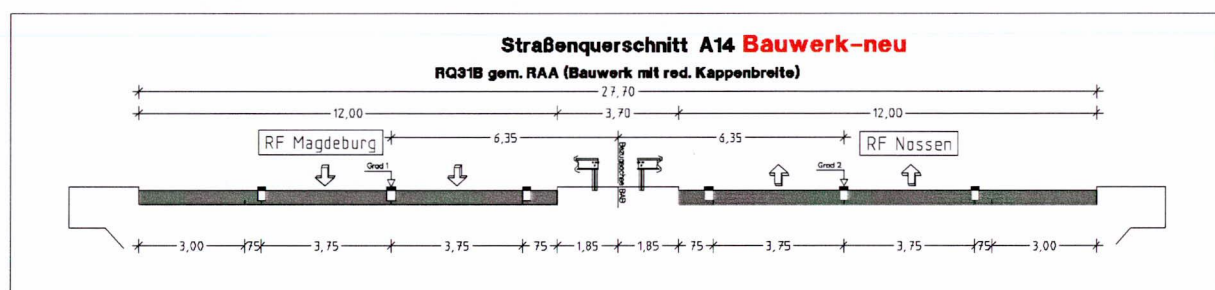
geplanter Straßenquerschnitt RQ 31B im Bauwerksbereich
